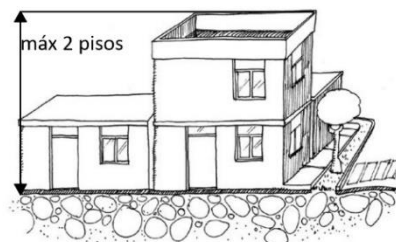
Reglas generales a tener en cuenta para la construcción con mampostería confinada.
